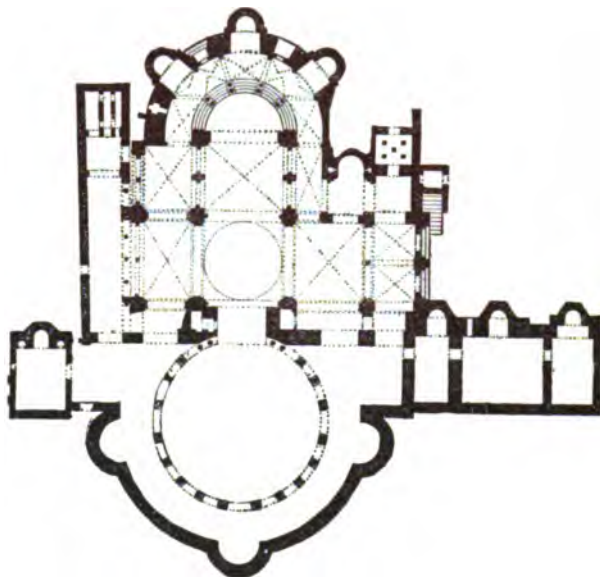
Grundriss der Heiliggrabkirche zu Jerusalem.
